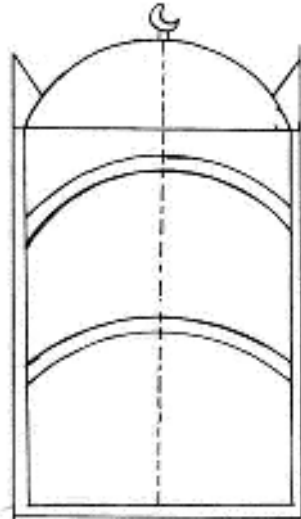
المسقط الأفقي لمسجد الساعدية (عن مسعود البلوشي)
